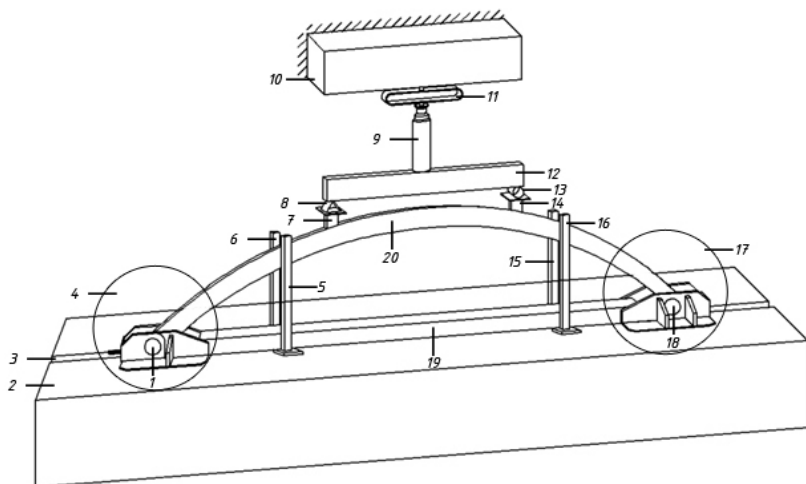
Стенд для испытания моделей железобетонных арок с двухшарнирной схемой опирания
